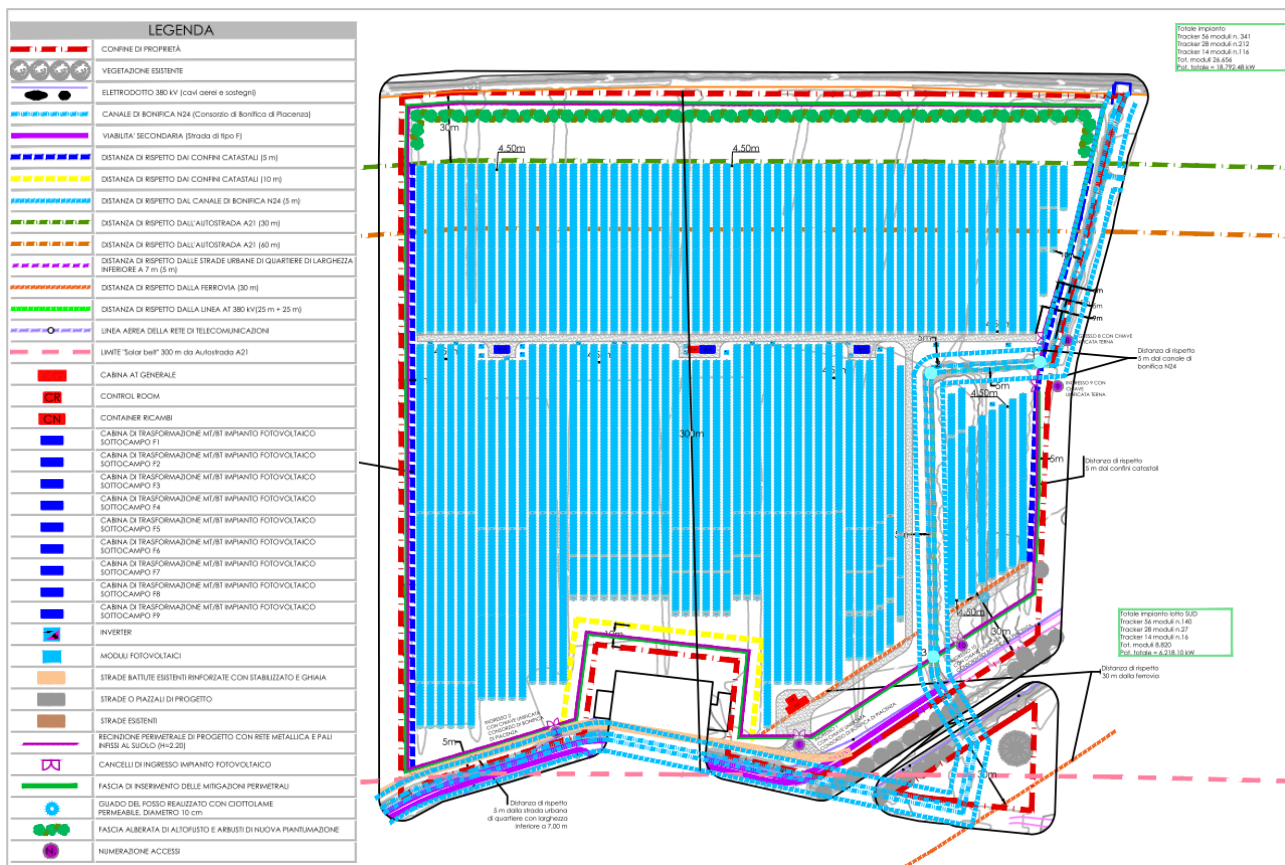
Planimetria di dettaglio dell'Area SUD dell'Autostrada A21
